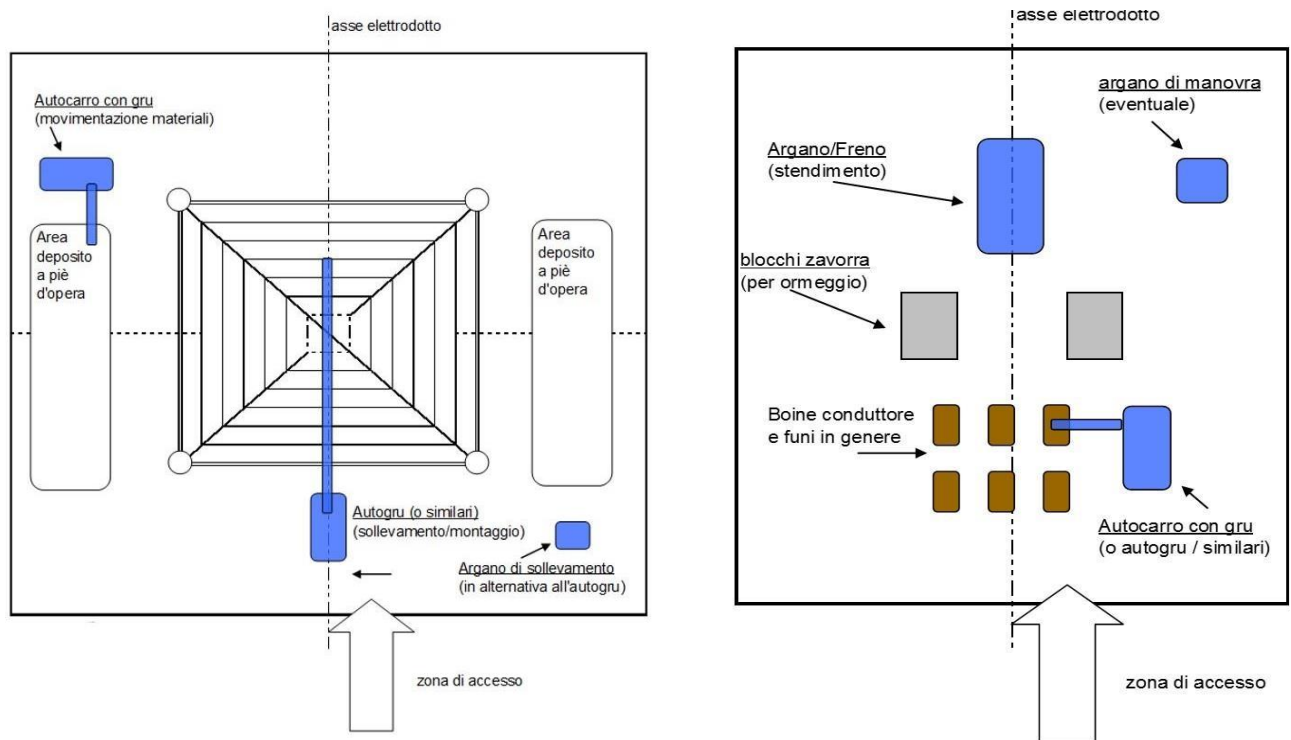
Destra: Planimetria dell'Area Sostegno (montaggio sostegno) – Sinistra: Planimetria dell'Area di linea - Tipologico
